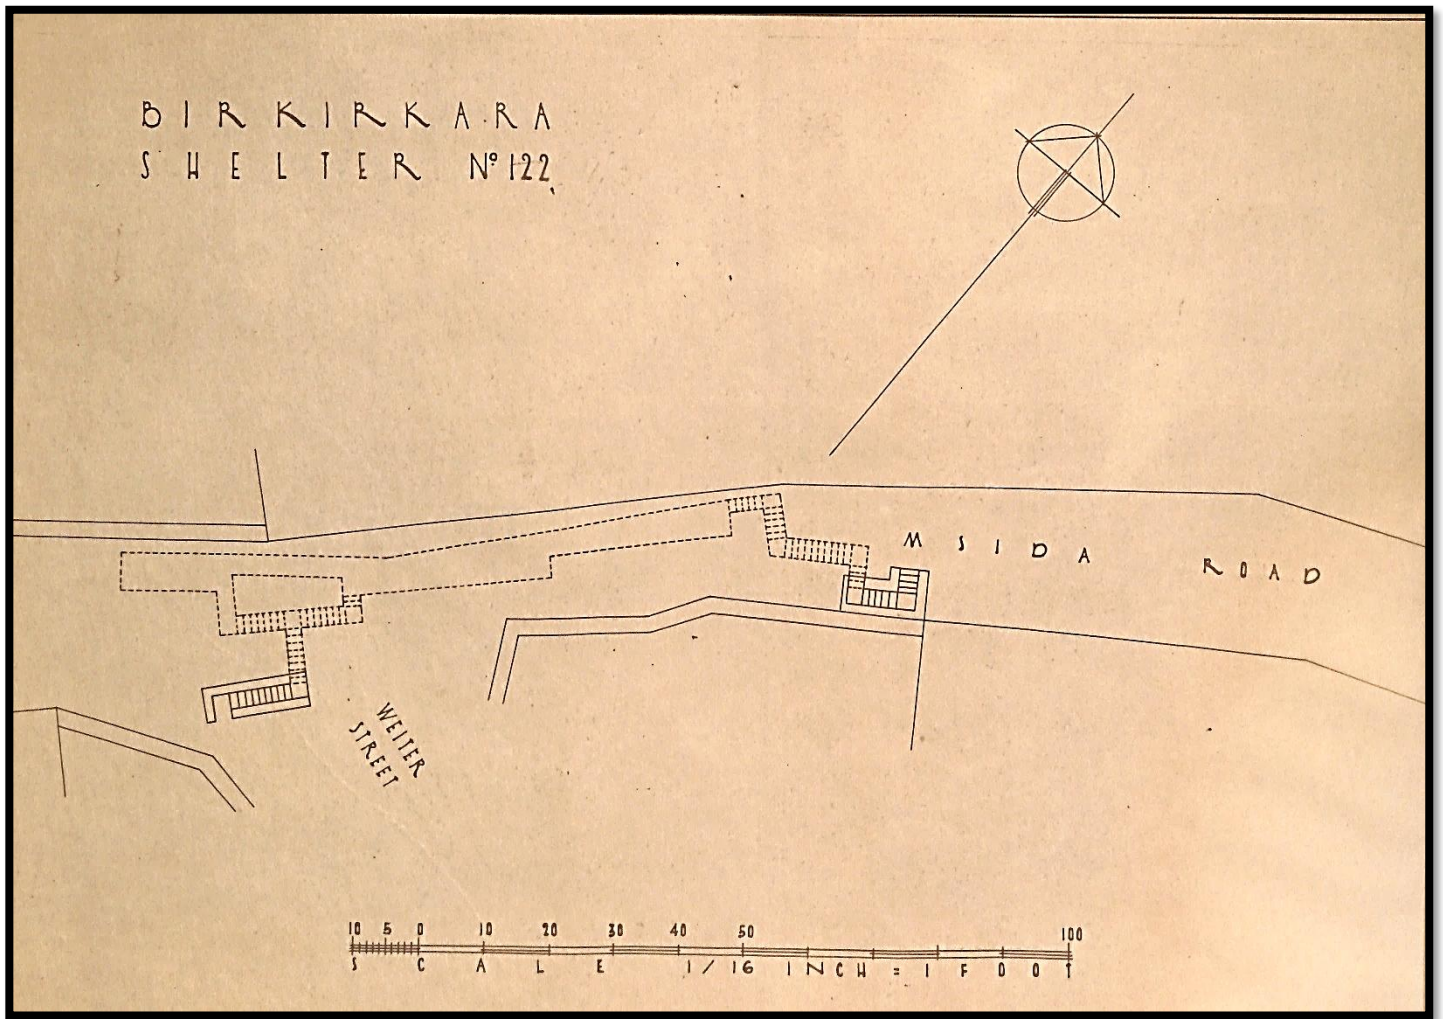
Planta do Abrigo nº 122 "Msida Road"
